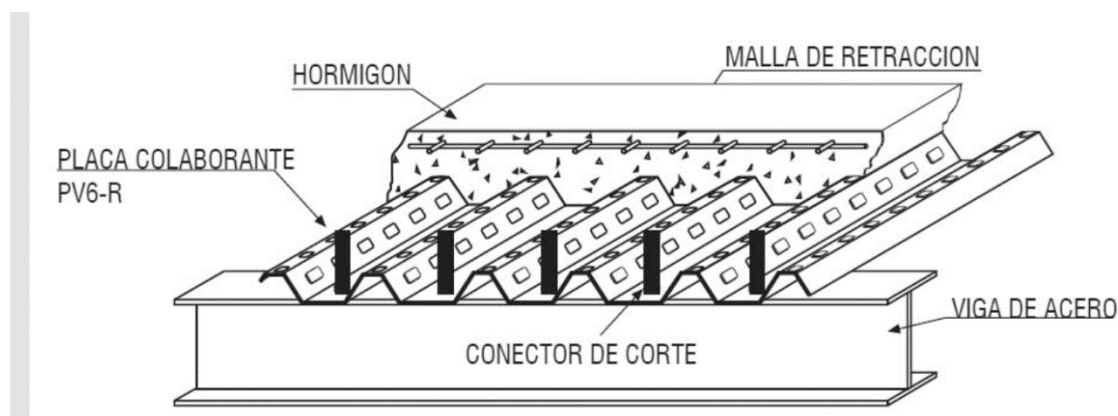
Losa colaborante. Fuente Arquitecturaenacero.
